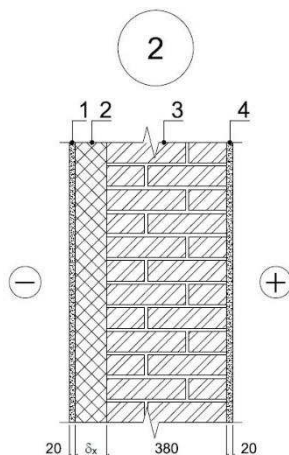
Вариант 2 конструкции наружной стены
